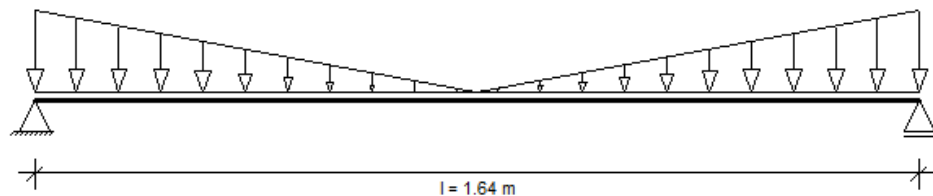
Berücksichtigung der Gewölbewirkung zur Bemessung der Holzausfachung (BGU, 2016)
